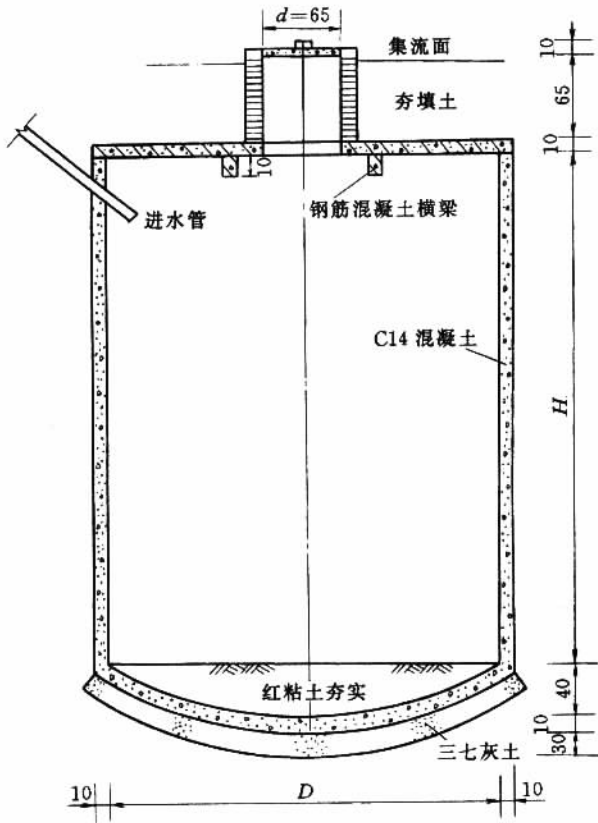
甘肃圆柱形混凝土蓄水池示意图 (单位: cm)
